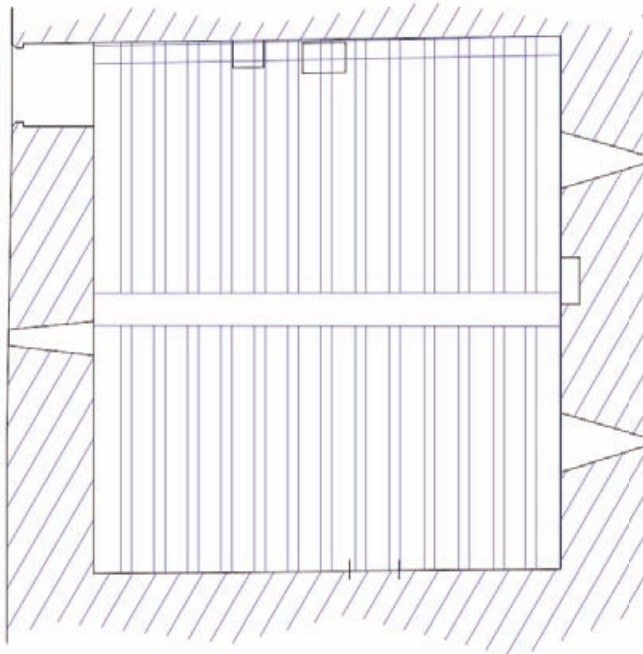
Plan du niveau 1 (DAO : P. Lhomme)
